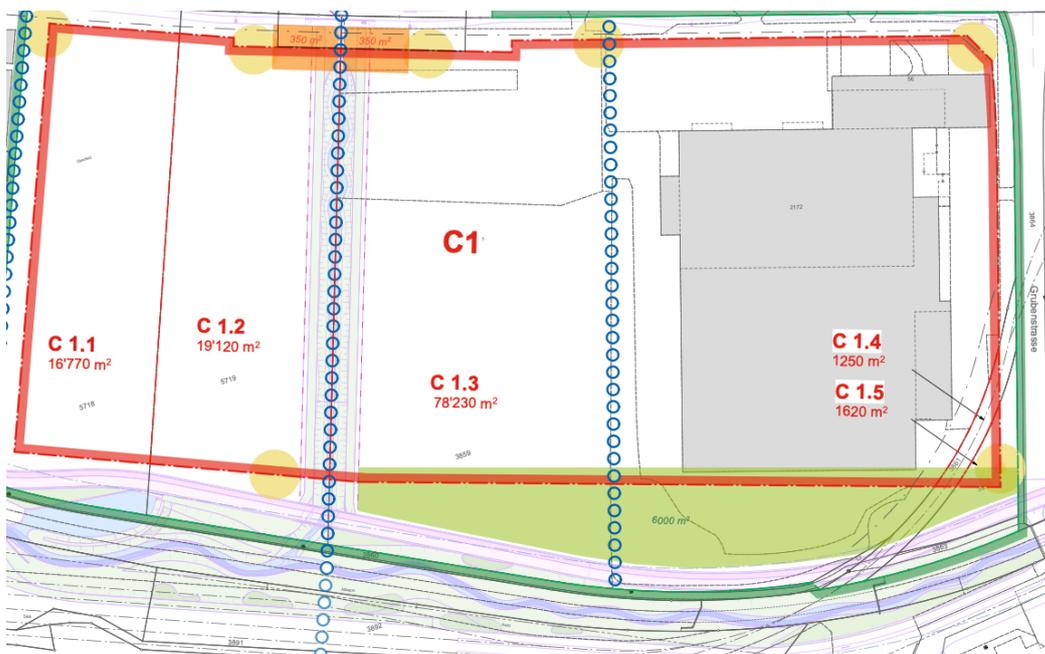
Ausschnitt aus Ergänzungsplan Steinacker mit geplantem Bedenseebach im Baufeld C1
